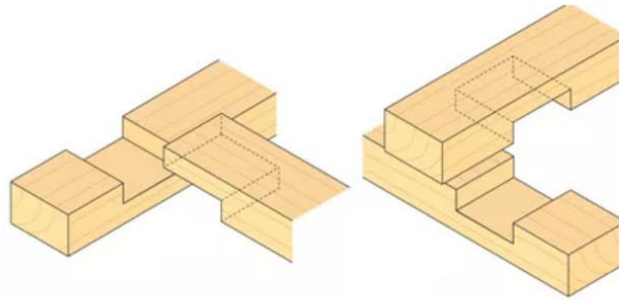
Assemblage bois-bois permettant aux poutres de rester dans le même plan [13]
